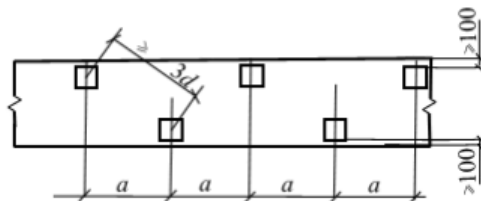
Схема расположения свай в рядовом фундаменте
